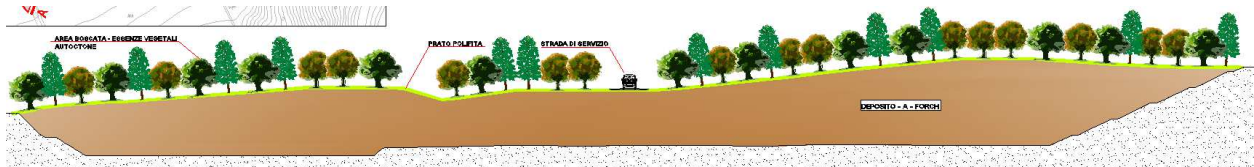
Sezione della planimetria opere a verde in corrispondenza del deposito definitivo A - Forch.
